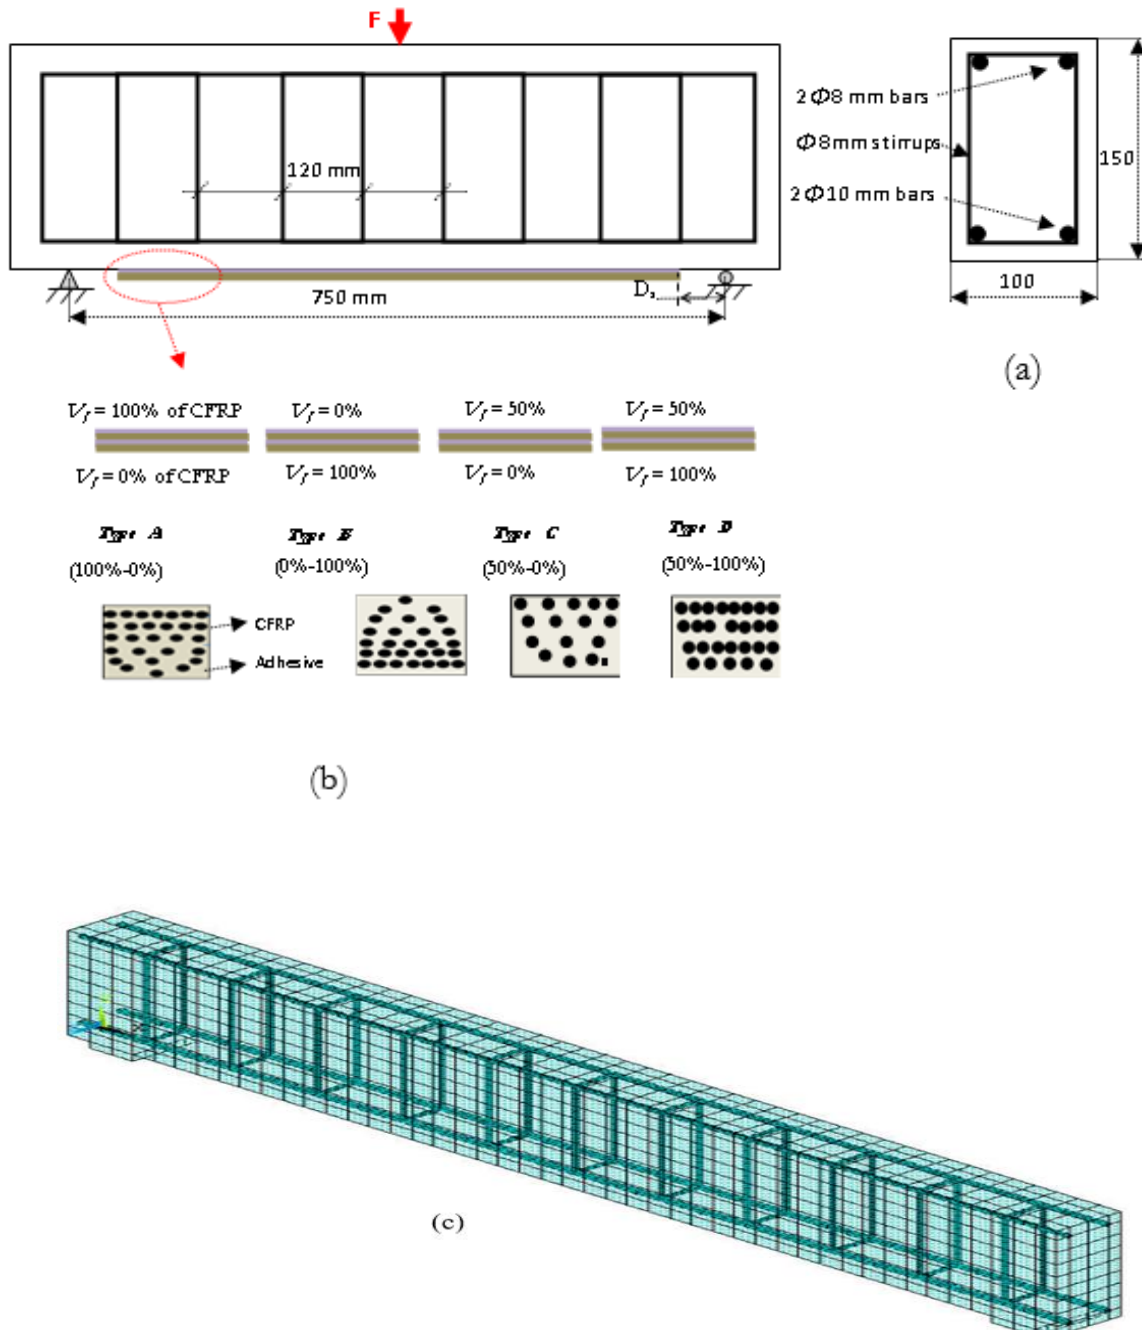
(a) Détail de la poutre en BA, (b) Détails des poutres en BA renforcées par une plaque FRP, (c) Maillage du béton et configuration de l'armature.
